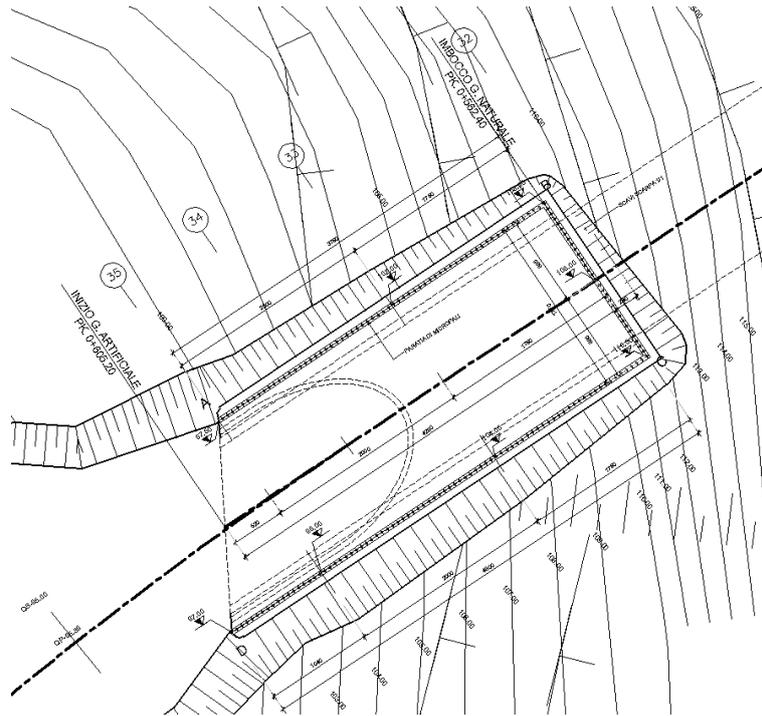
Planimetria degli scavi all'imbocco della galleria di emergenza
